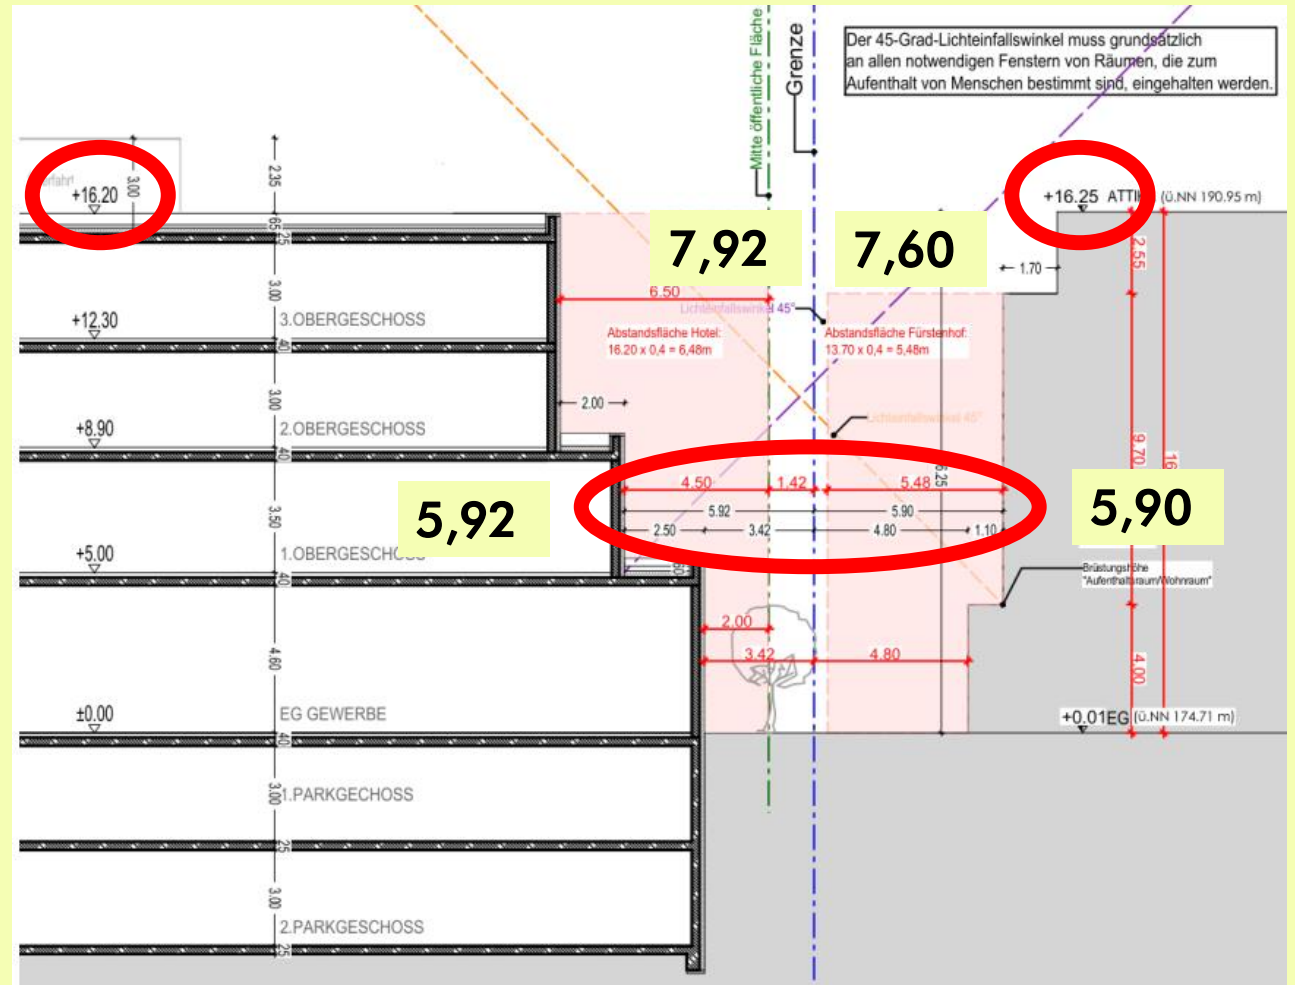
Systemschnitt zur Verschattung/Belichtung des Fürstenhofes (Stand Jan. 2021)
